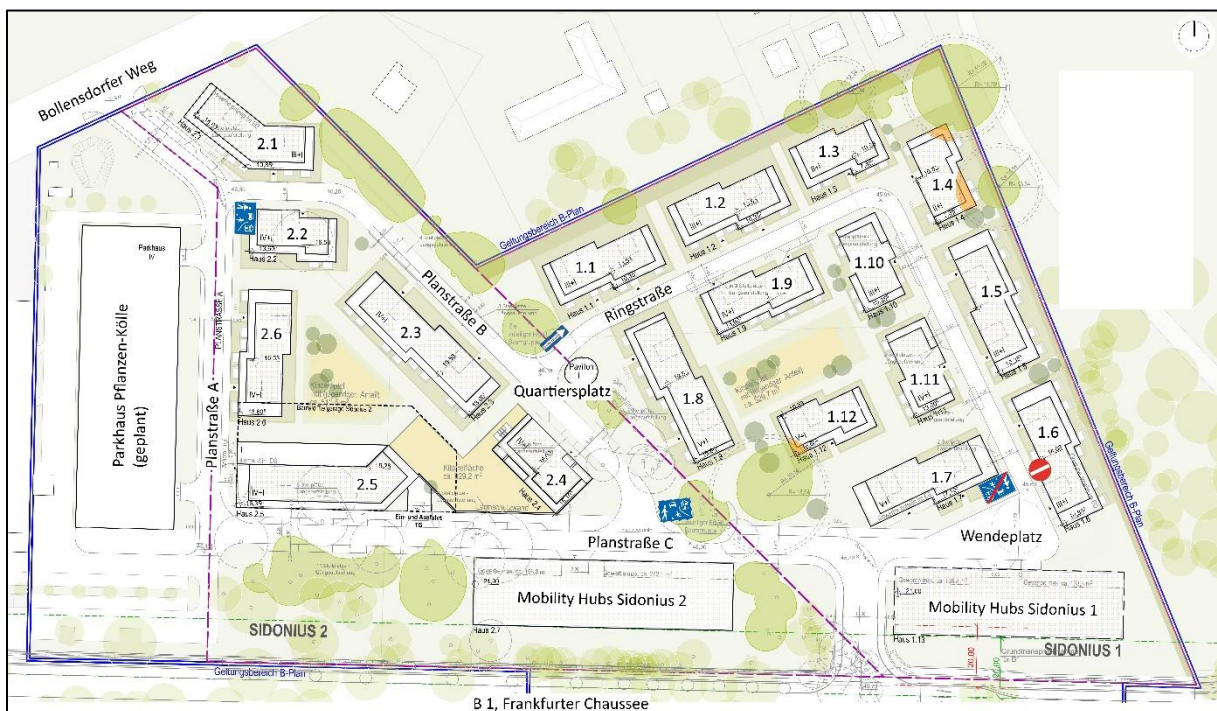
Lageplan aus dem Städtebaulichen Entwurf „Rennbahnquartier Hoppegarten“, Stand 04.09.2023
